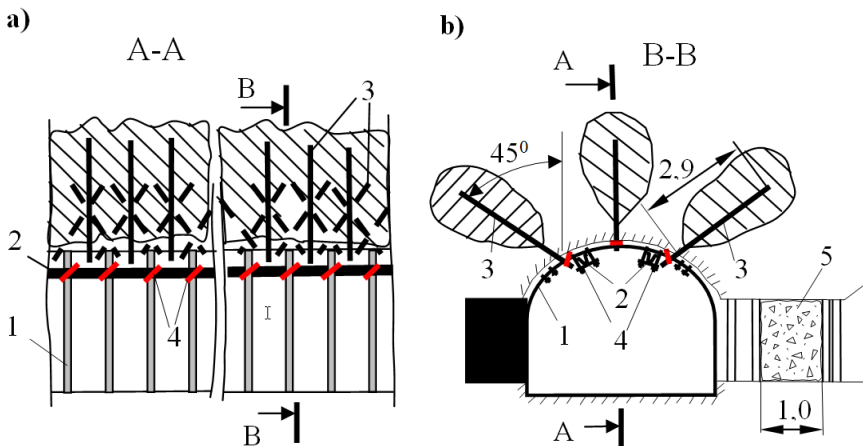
Комбинированный способ обеспечения устойчивости подготовительной выработки: 1 арочная крепь; 2 – продольная балка из СВП-27; 3 – сталеполлимерный анкер; 4 – элементы крепления балки к верхняку крепи; 5 – литая полоса из цементно-полимерной смеси в пластиковой оболочке
